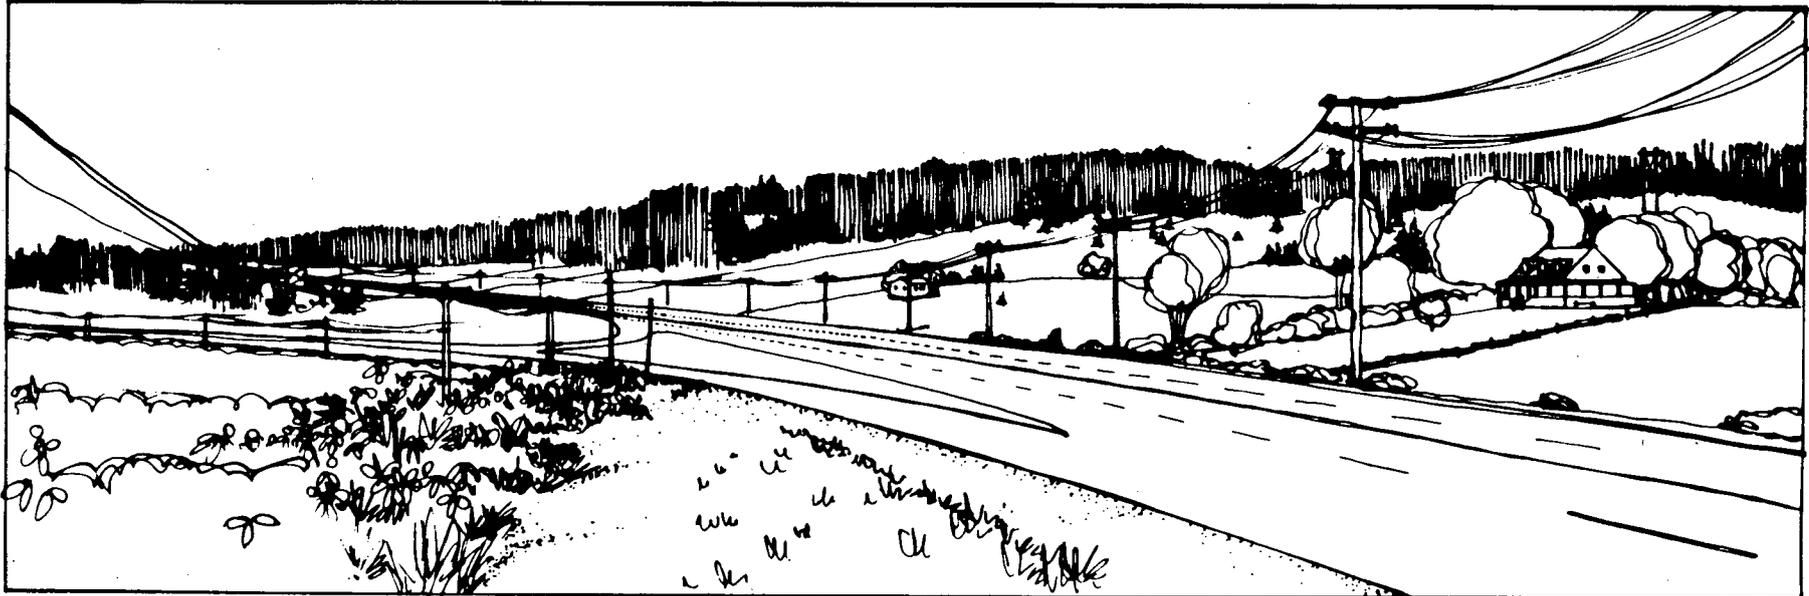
Raccordement de l'autoroute 73 à la route 173 (sans viaduc) à Beauceville-Est
